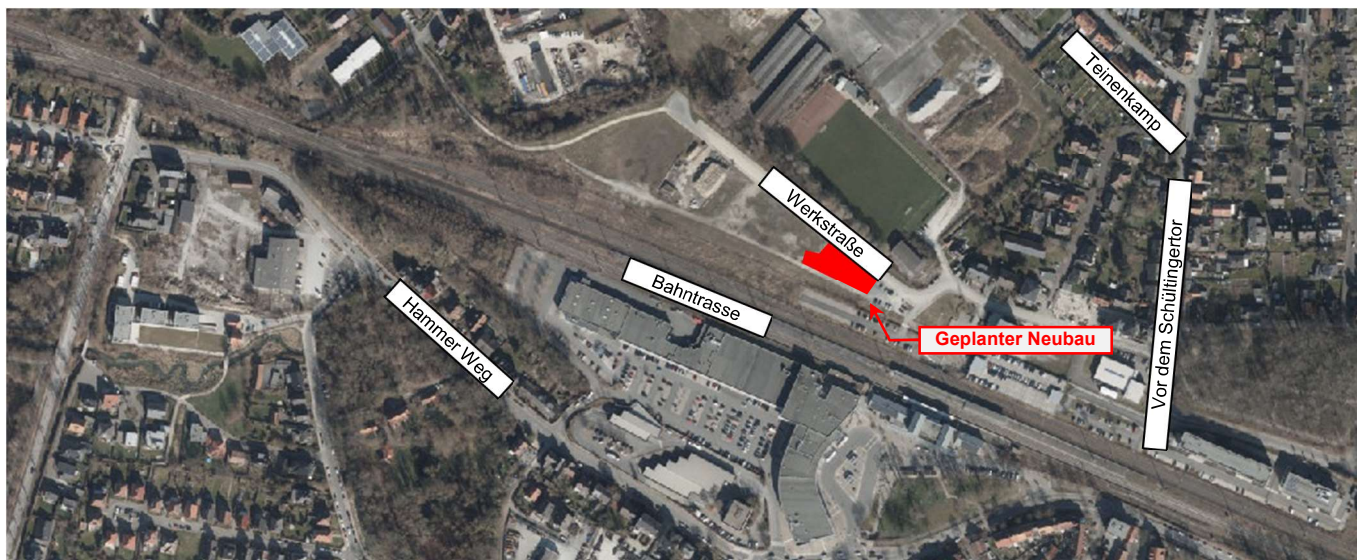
Lageplan, genordet, mit schematischer Darstellung des Bauvorhabens (rot) und Kennzeichnung der wesentlichen immissionsrelevanten Schallquellen (Quelle: www.geoportal.nrw)
